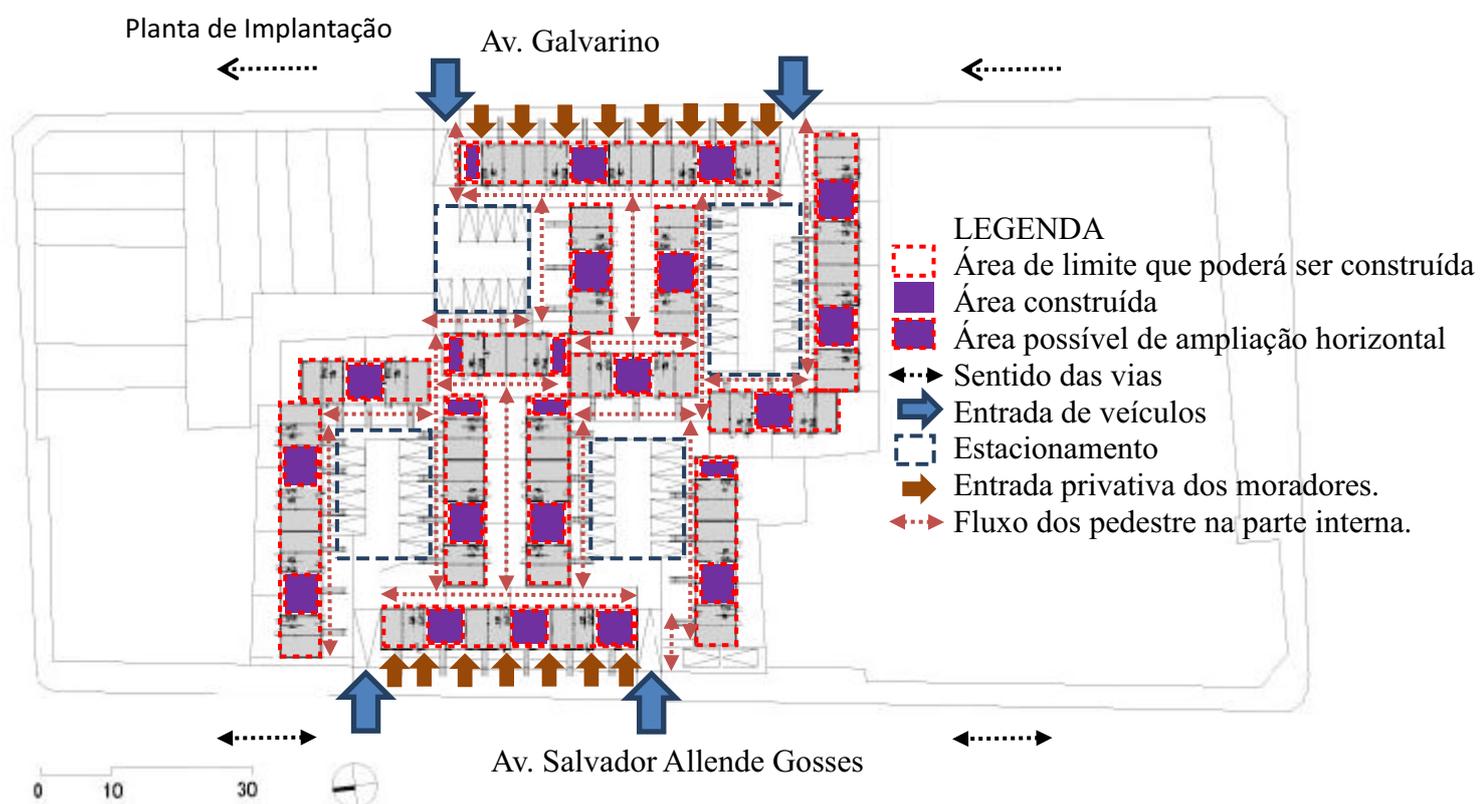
Quinta Monroy Planta de Implantação Fonte<: Archdaily > Acesso em Março de 2019
